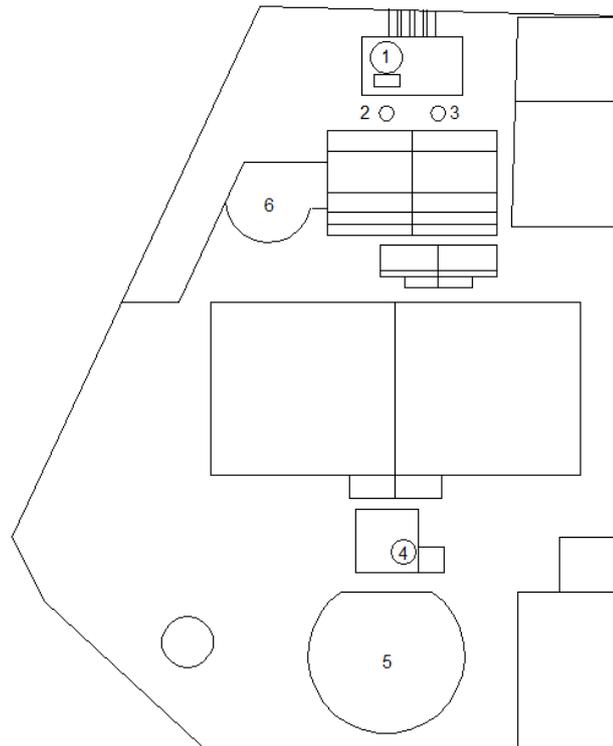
Tanques en la Planta de Potabilización BAYAS
